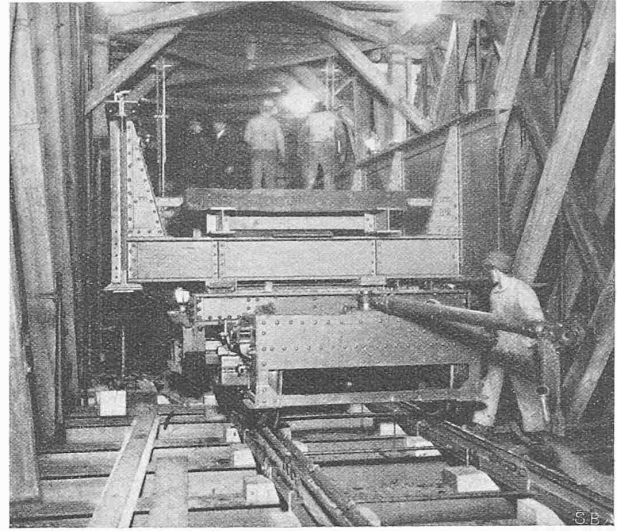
Auf Schemelwagen in die hölzerne Brücke eingefahrener Teil der eisernen Balkenbrücke.
